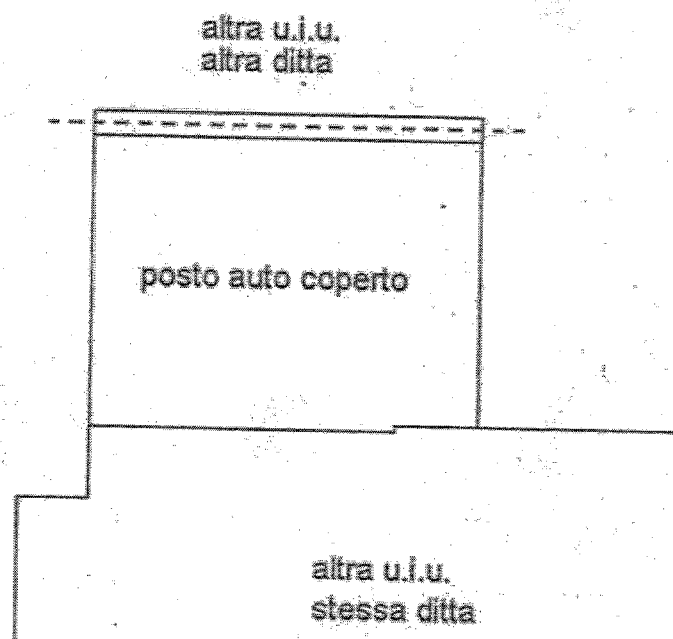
planimetria catastale, sez. B foglio 3, mappale 39 sub 6 (fuori scala)
